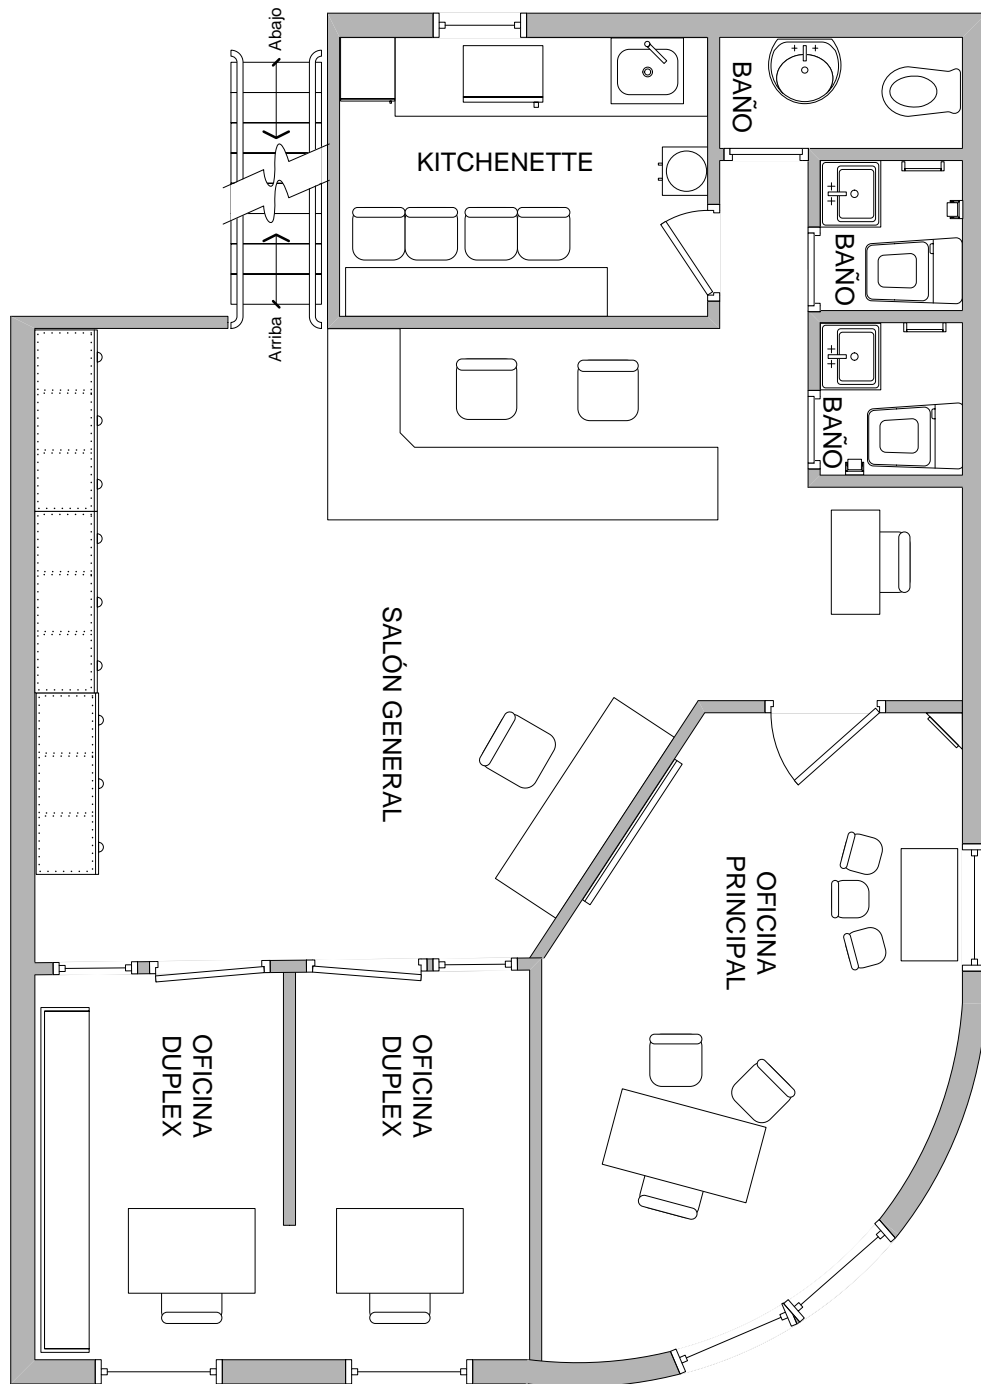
Planta Alta de la Sede Principal de Intrave C.A.
